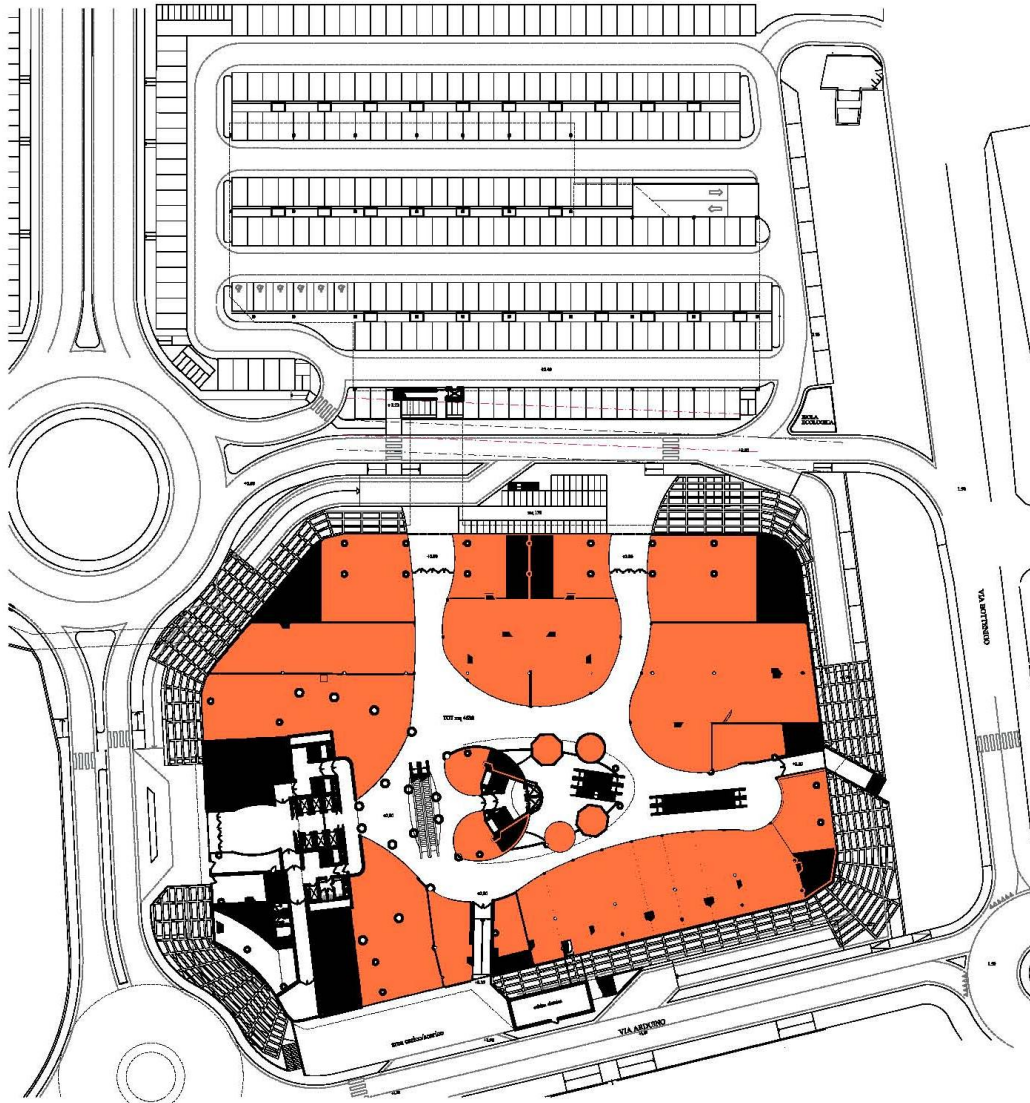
pianta dell'edificio a torre e della vicina area di parcheggio già realizzata
